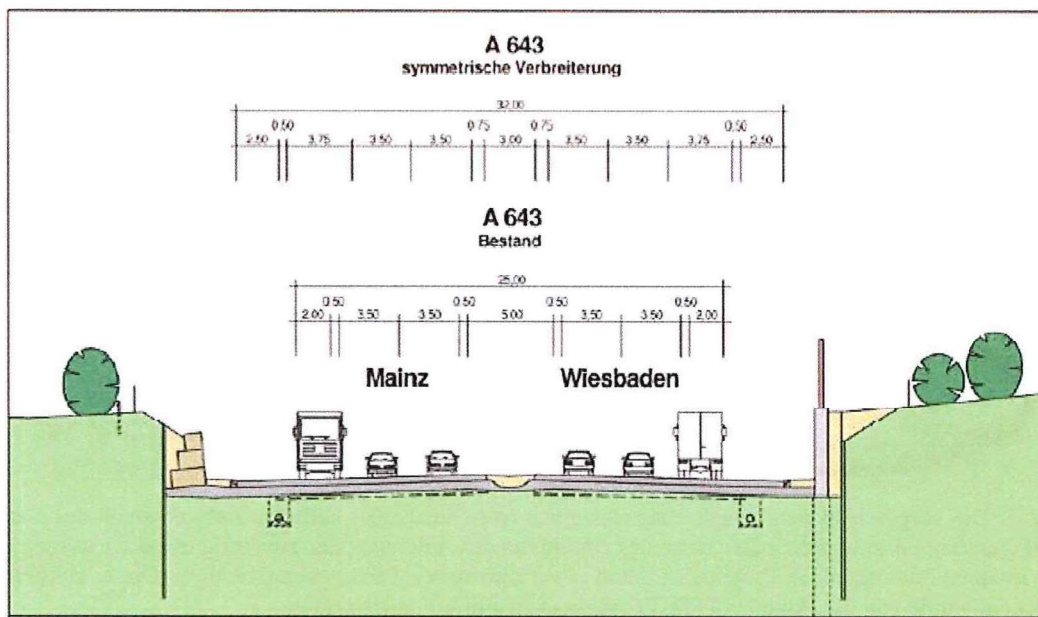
Ein Vergleich zwischen der bestehenden Autobahn mit 4 Fahrspuren (unterer Bildabschnitt) und dem geplanten Projekt mit 6 Fahrspuren (oberer Bildabschnitt).
